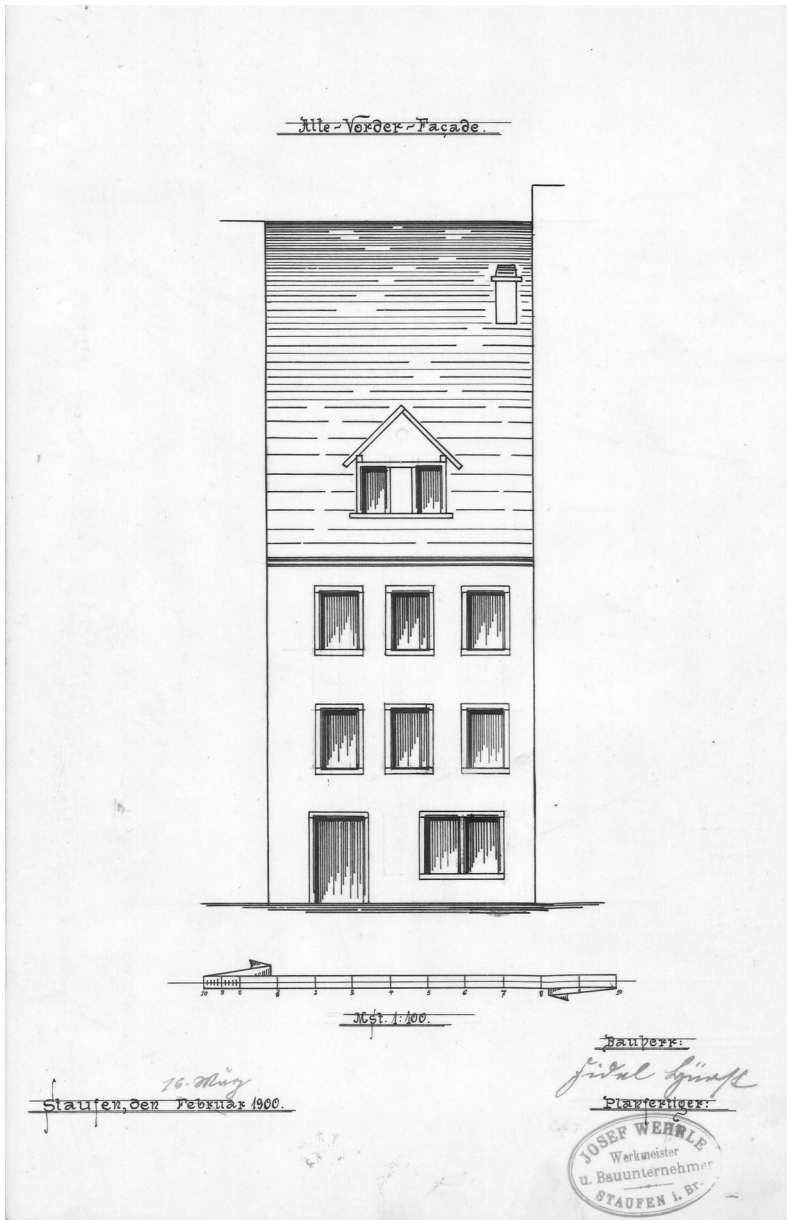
Hauptstraße 51, Straßenansicht von 1900.
